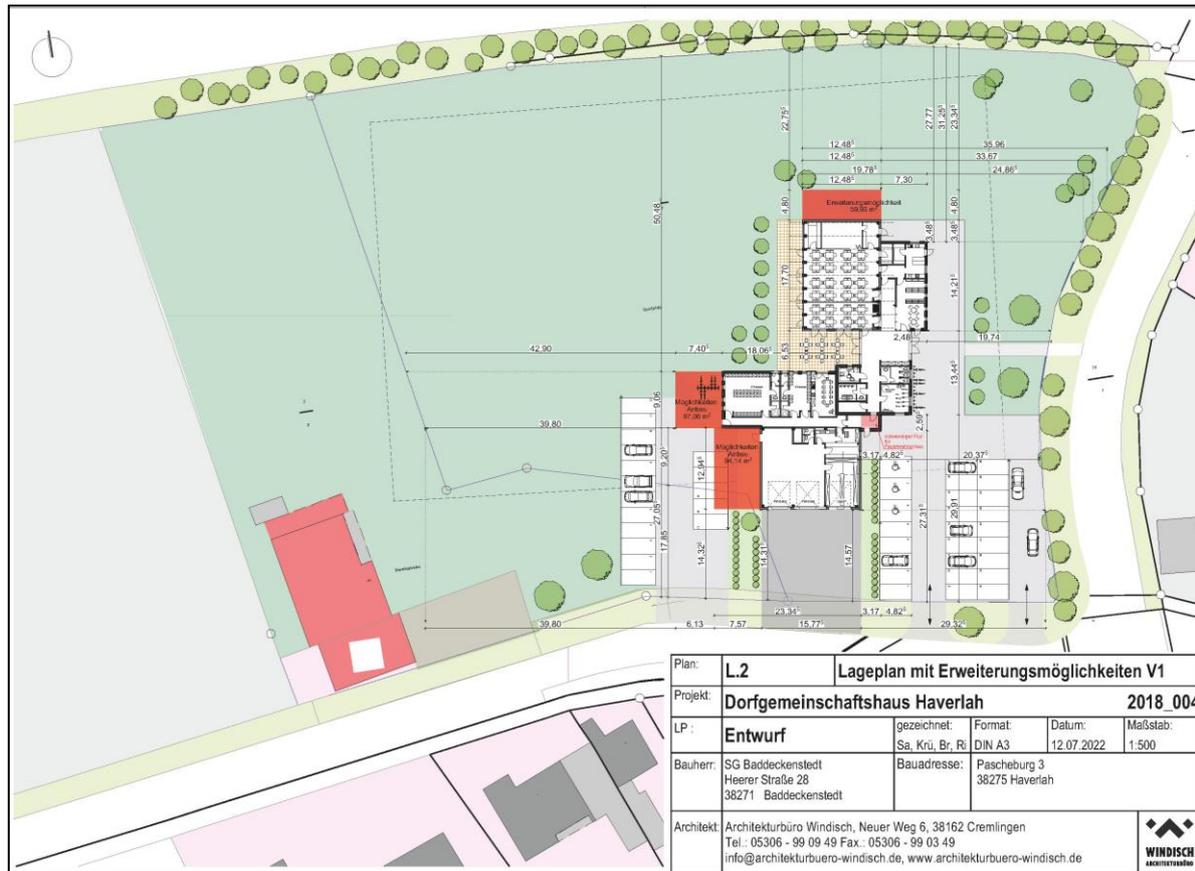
Lageplan mit Erweiterungsmöglichkeit für die Feuerwehr (Dorfgemeinschaftshaus Haverlah, Entwurf, Architekturbüro Windisch, 07/2022). Links unten im Bild der vorhandene Gebäudekomplex aus Feuerwehr u. ehemaligem Sportheim.
